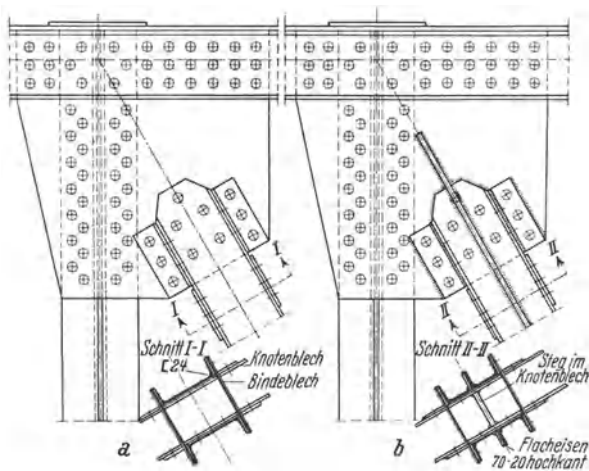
Brückenverstärkung durch Schweißung.
